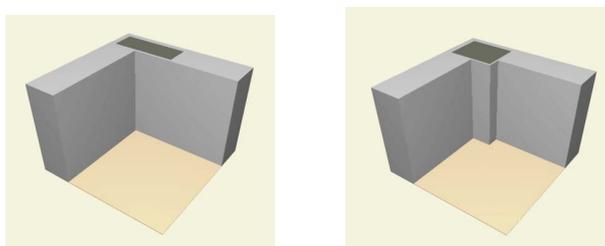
Exemplo de estrutura embebida e saliente em paredes
